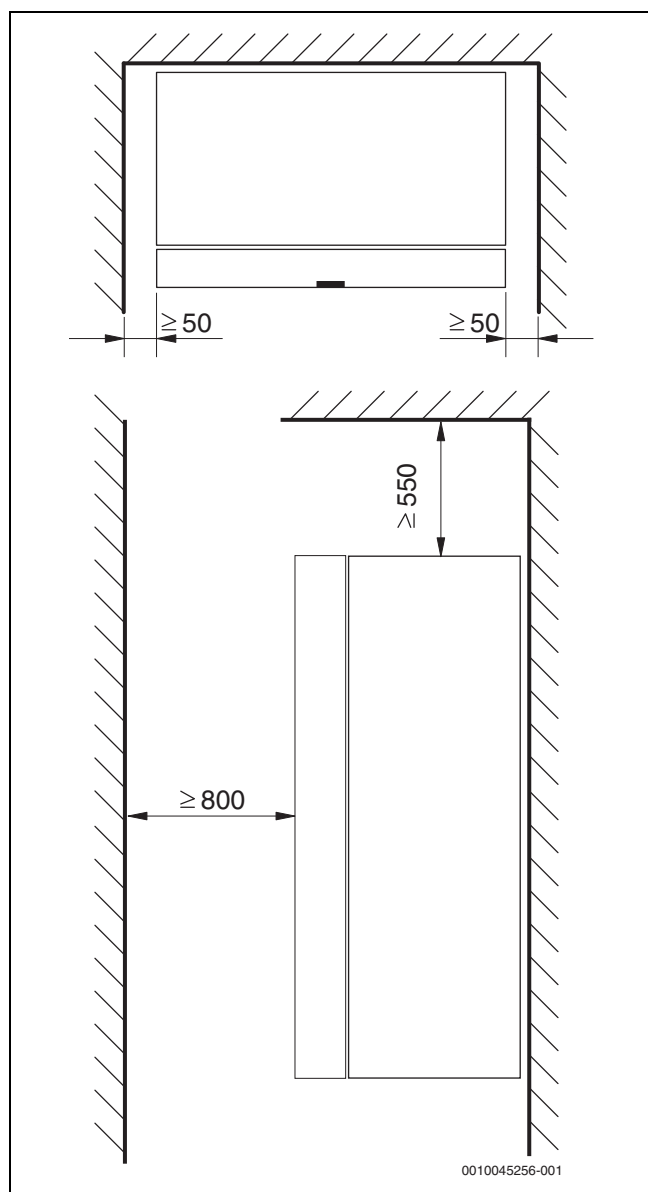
Mindestabstände zu Wänden und anderen Gegenständen (Maße in mm)
